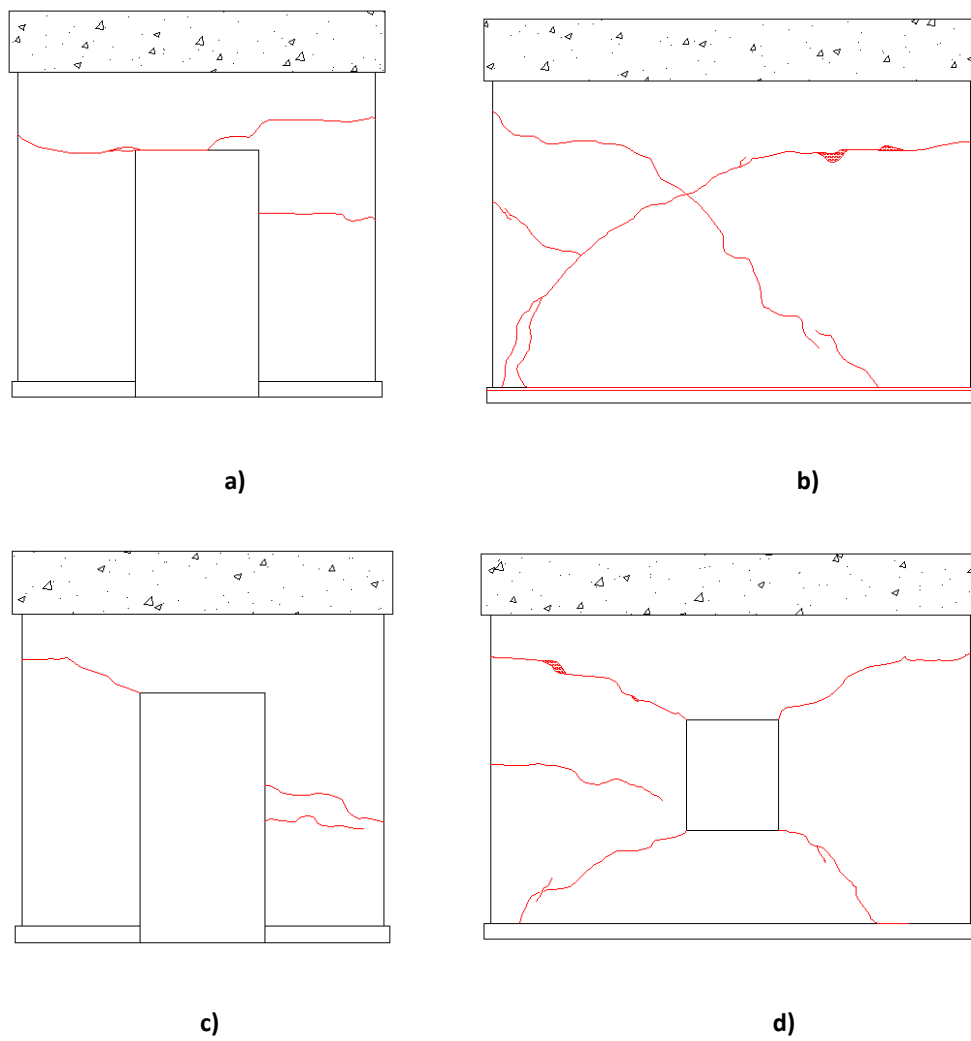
Fissuração no final do ensaio: a) Fachada Este b) Fachada Norte c) Fachada Oeste d) Fachada Sul
